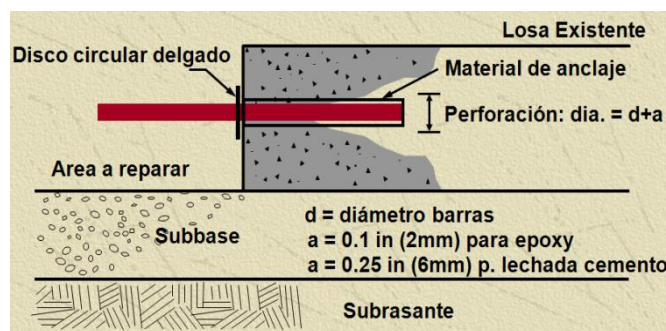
Vista de perfil. Detalle de colocacion de dovelas.
